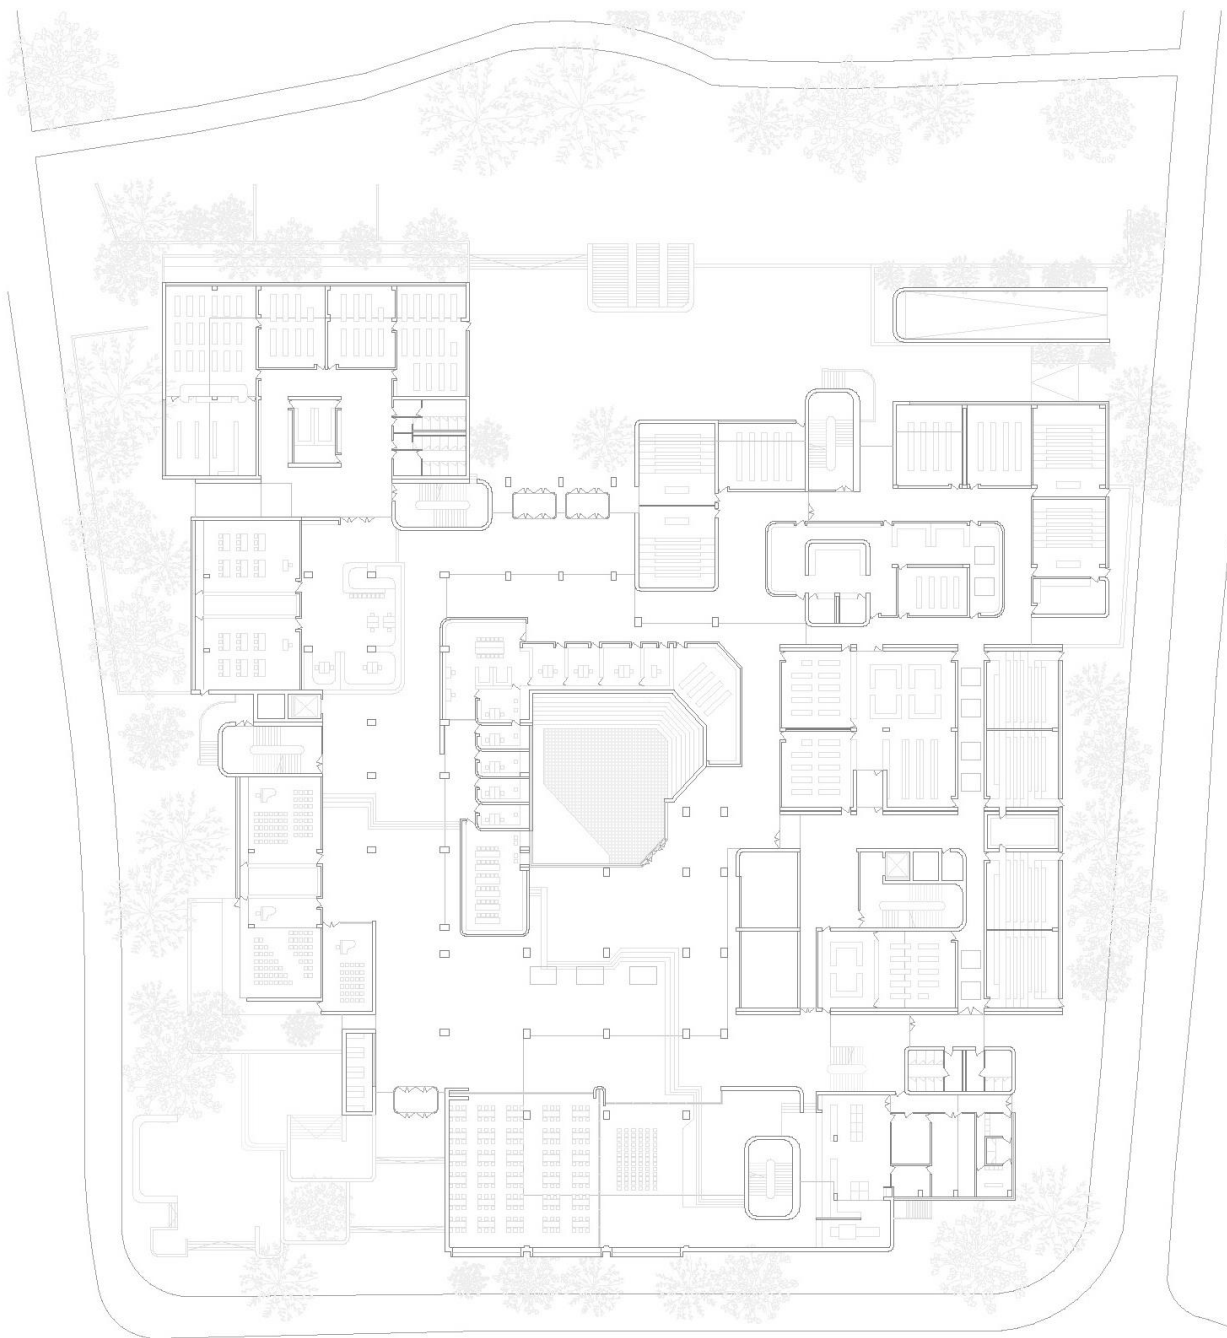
Abb. B: Grundriss EG, Planungsstand Genehmigungsplanung 1972 (Eigene Grafik nach Eingabeplanung LBK)
